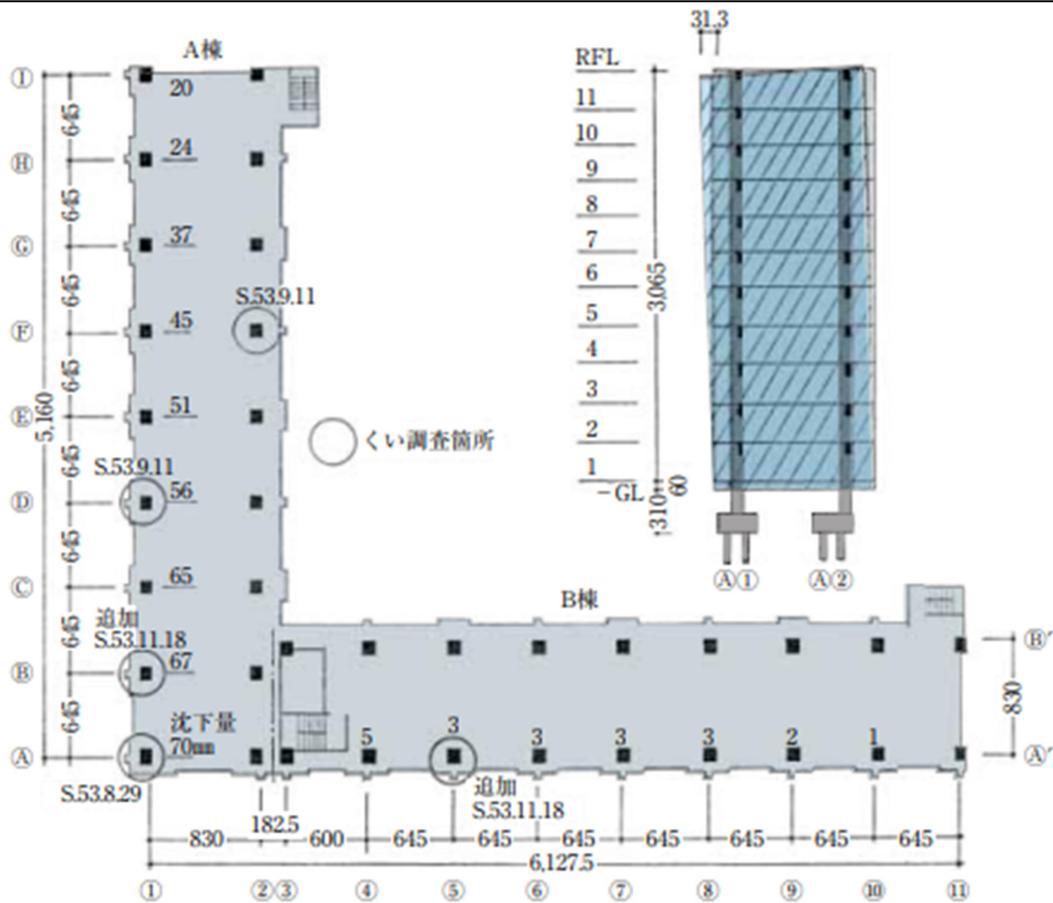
傾いた11階建てマンションの平面図 左が傾いたA棟、右がB棟
